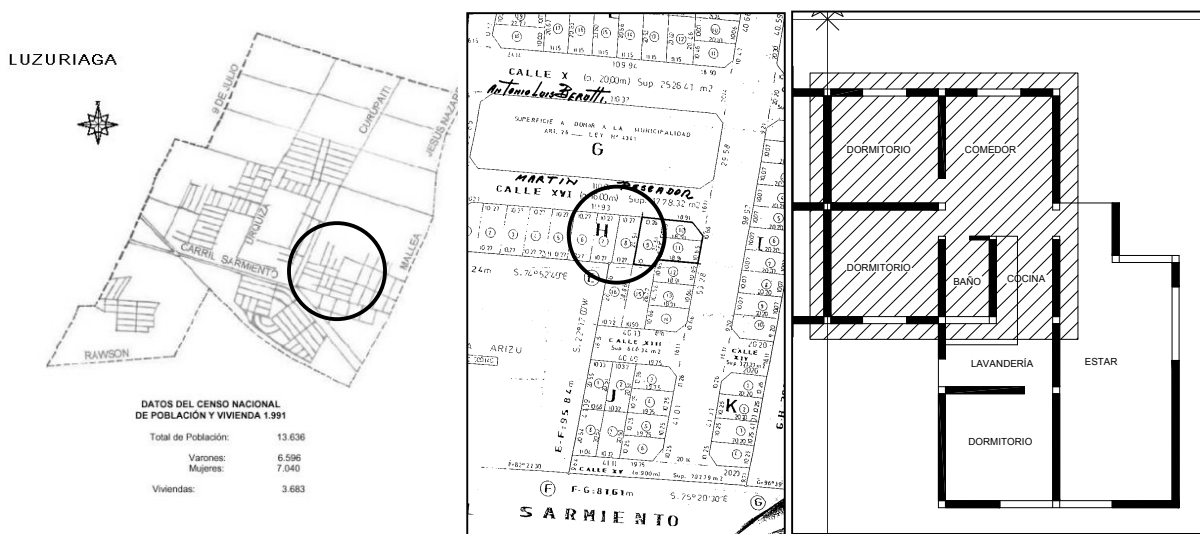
Plano del Distrito de Luzuriaga, Loteo del Barrio y Planta de la Vivienda analizada.
